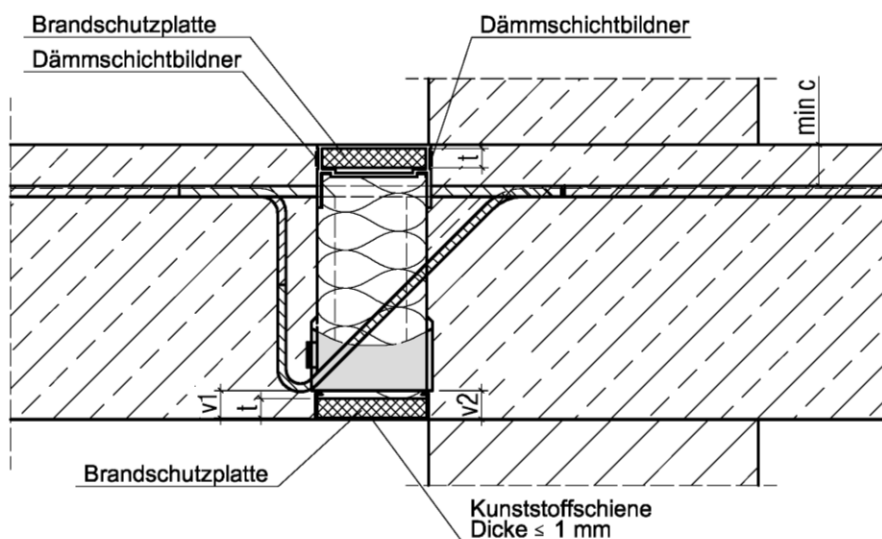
Schöck Isokorb® Typ K und Typ KF (Ausführungsvariante A) gem. Abschnitt 3.1.2
